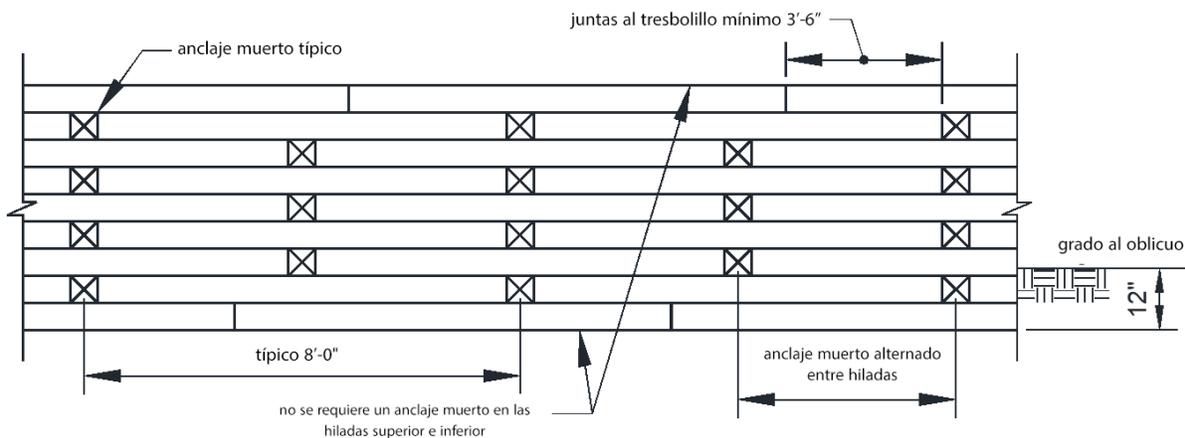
ELEVACIÓN TÍPICA DE UN MURO DE MADERA
